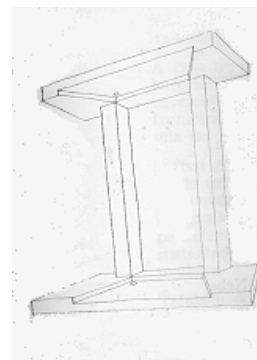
Solução de uma verga de madeira nas casas bandeiristas
